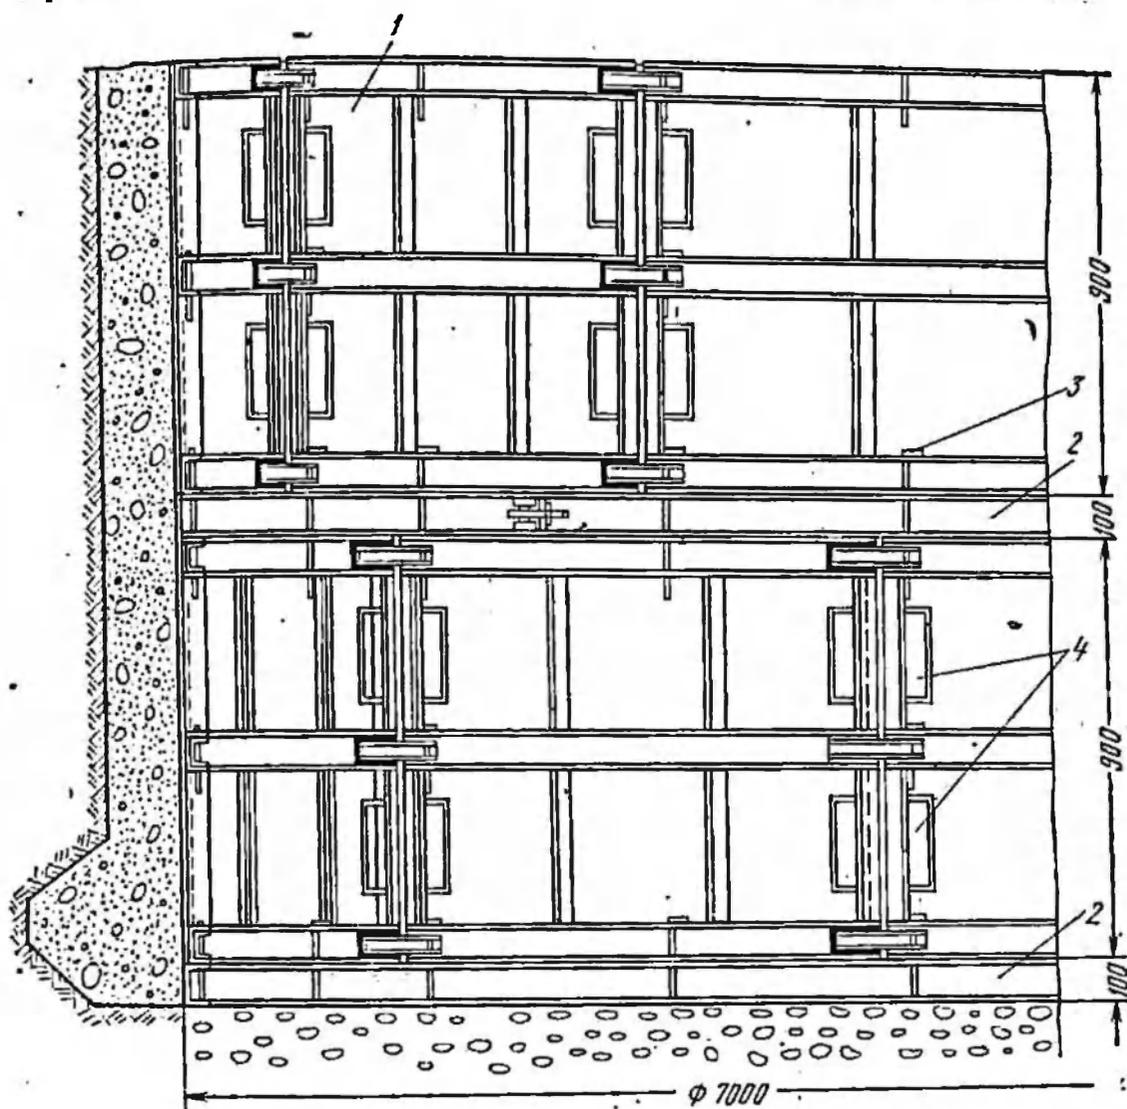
Секционная опалубка конструкции Шахтспецстроя:
